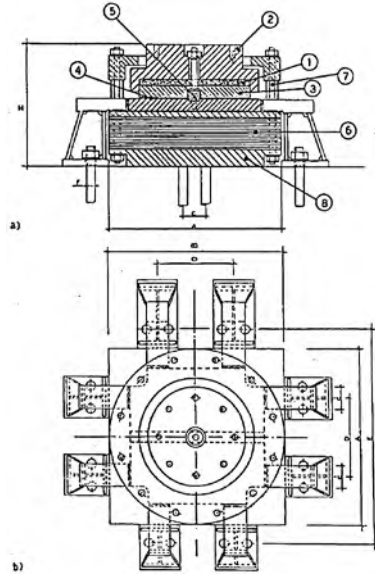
Sezione e pianta dell'apparecchio di appoggio
